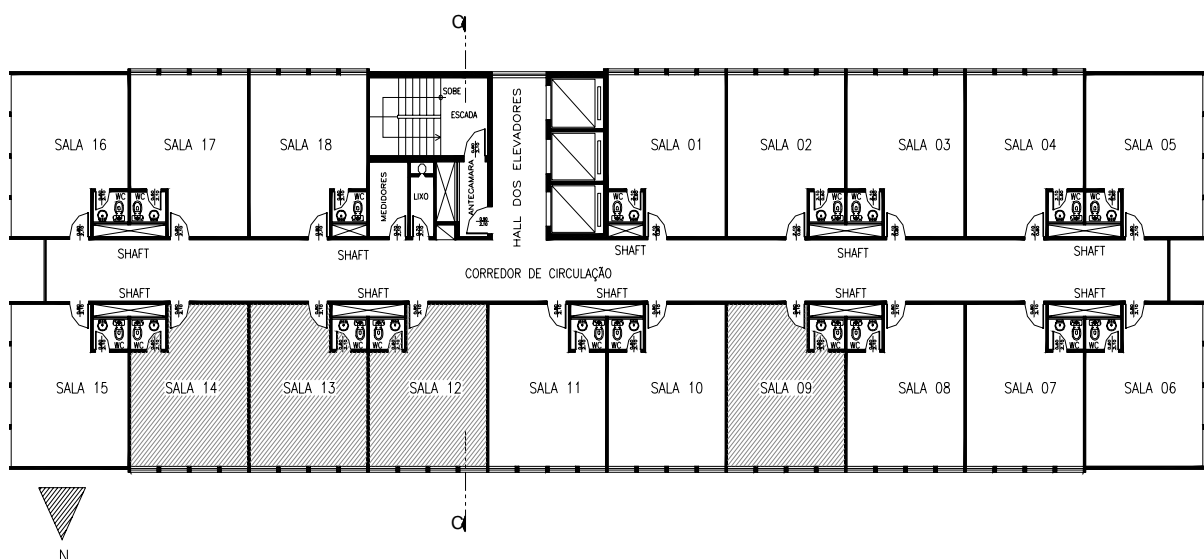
Planta baixa do pavimento-tipo escala 1/50 (reduzida)
